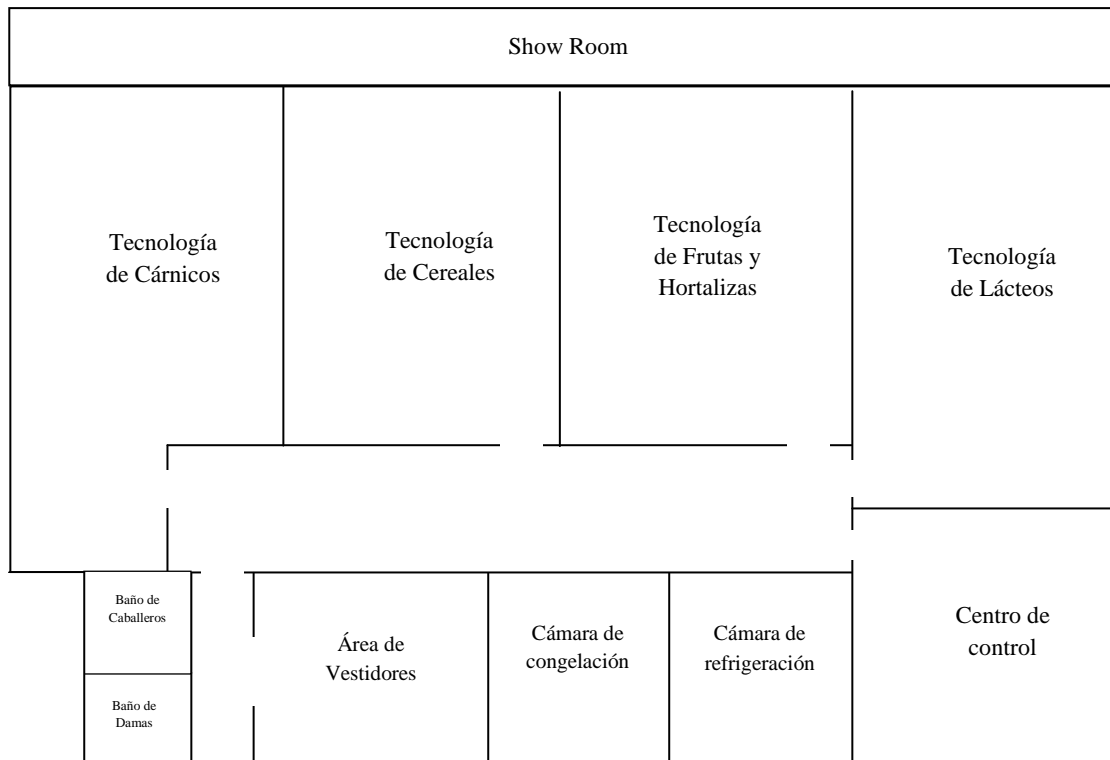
Distribución de la Planta Piloto de Alimentos de la UTE
